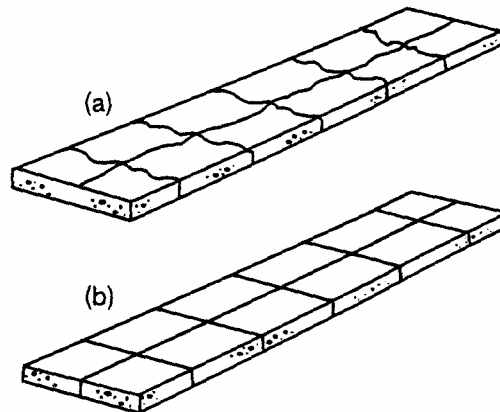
Patrón de agrietamiento provocado por el medio ambiente y los esfuerzos de las cargas en un pavimento de concreto sin juntas (b) Diseño adecuado de las juntas para controlar la ubicación y geometría de las grietas en un pavimento de concreto.
